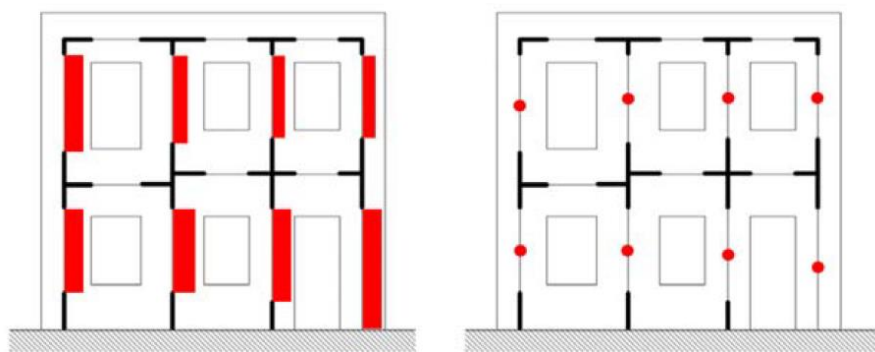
Andamento do diagrama de esforço transverso e respetiva localização das rótulas plásticas (Pereira, 2009).
